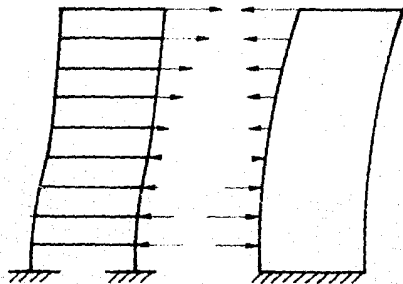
Interacción de fuerzas entre un muro y un marco ante cargas laterales.
